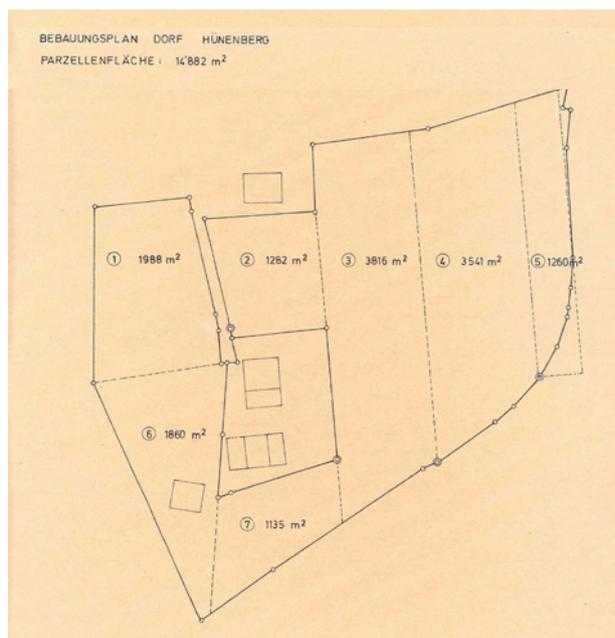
Ausschnitt aus der Nutzflächenberechnung der Baubewilligung über die Arealbebauung vom 19.05.1976 mit eingezeichneten Parzellenflächen
